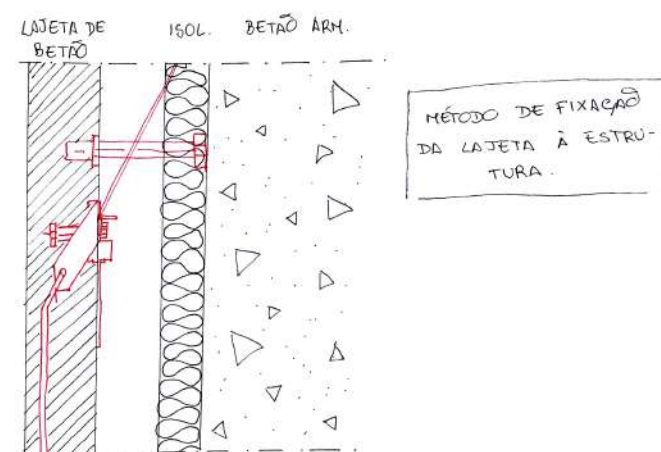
Método de fixação da lajeta de betão à estrutura.
